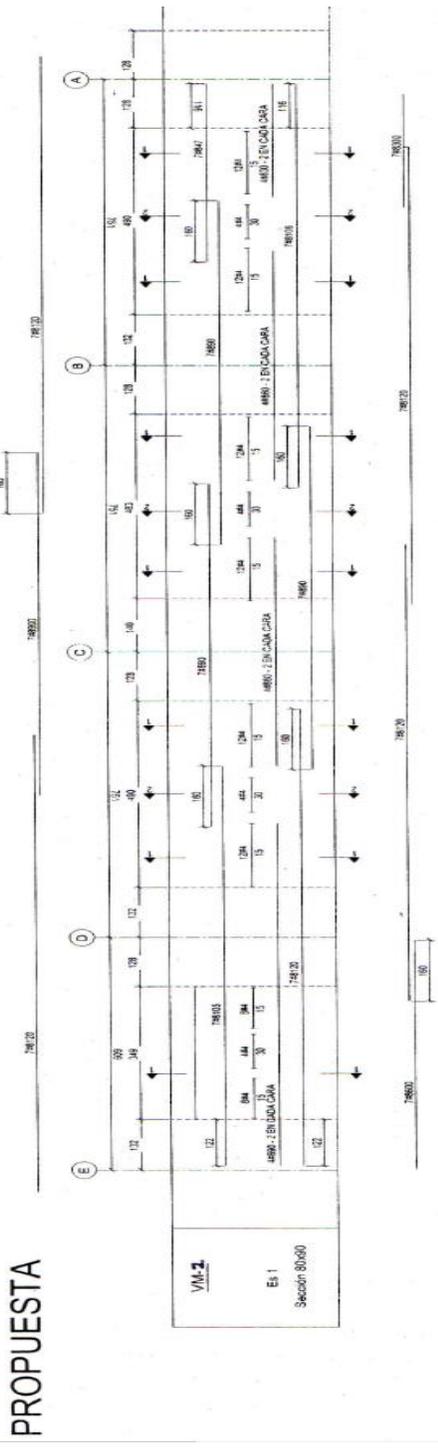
Despiece de refuerzo para Vigas – Muro.
